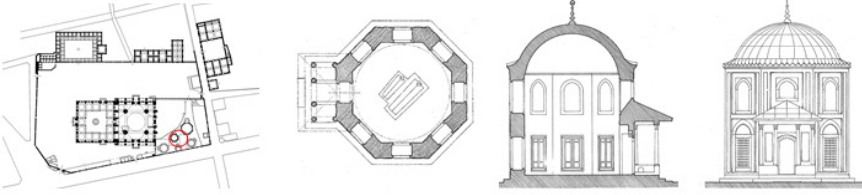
Şehzade Külliyesi Vaziyet Planı, Plan, Kesit, Görünüş (Ülgen, 1944)
